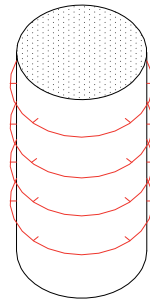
Principe de ferrailage du chemisage béton armé pour le renforcement au cisaillement.
